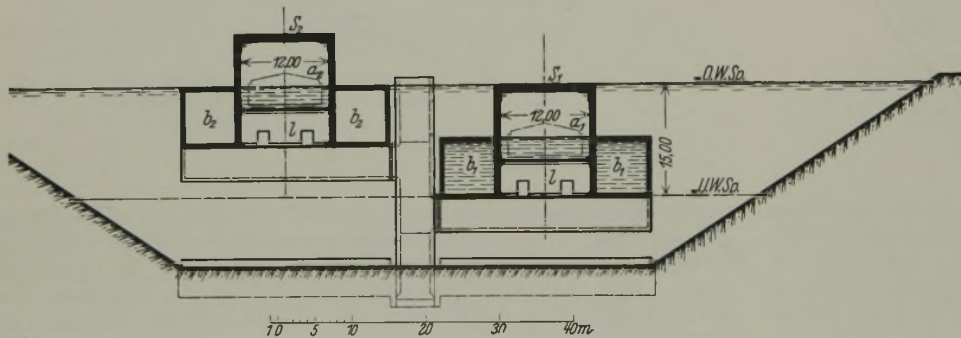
Grundquerschnitt, einstockige Bauweise.
